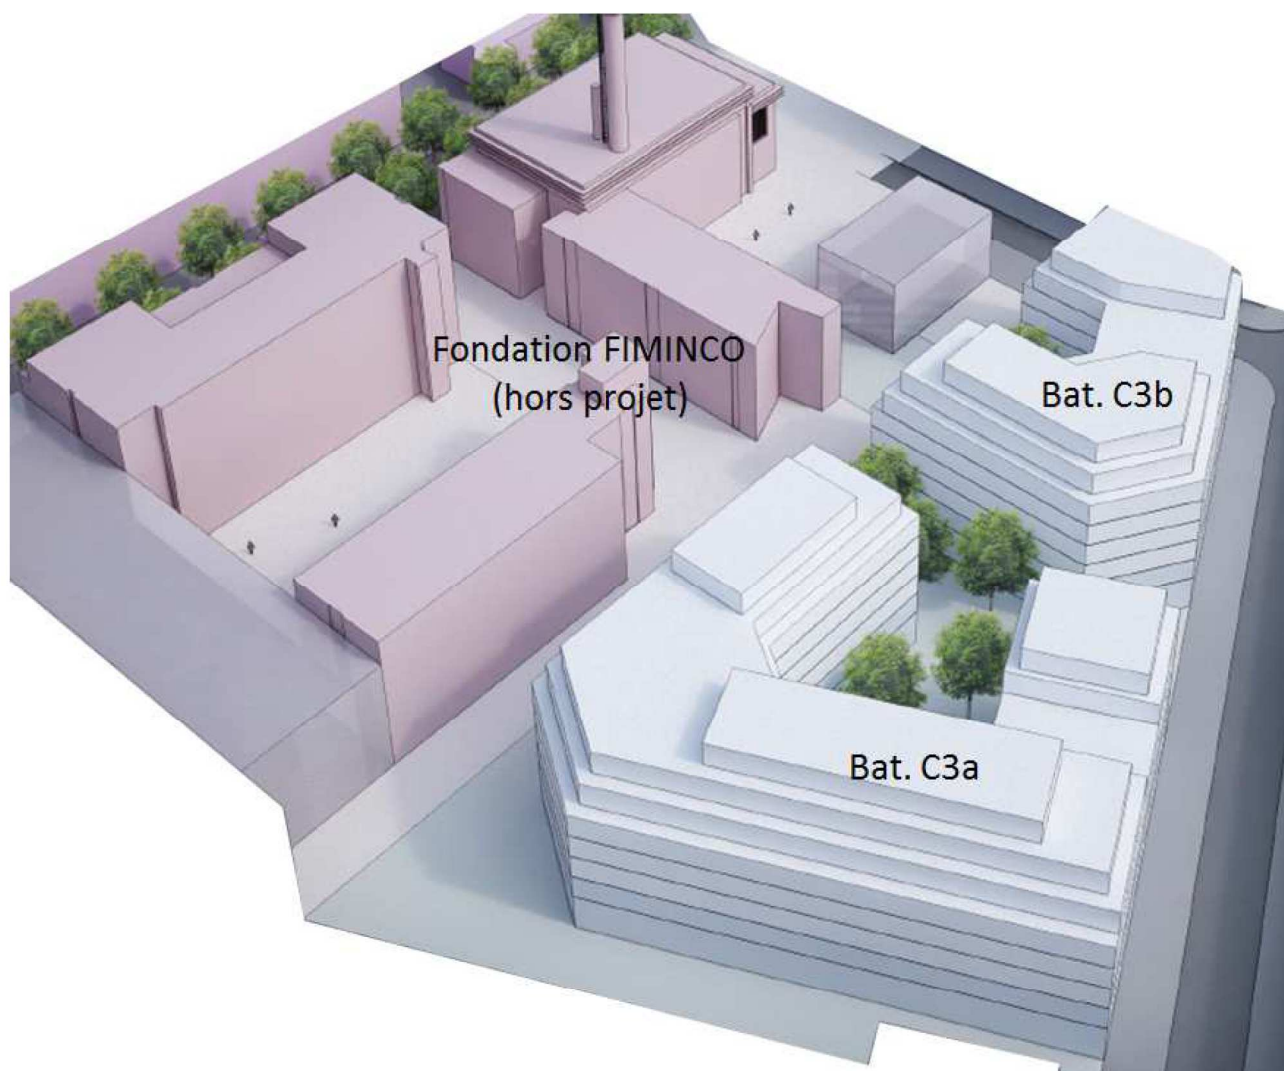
Hauteur des bâtiments (hors emprise FONDATION FIMINCO)
